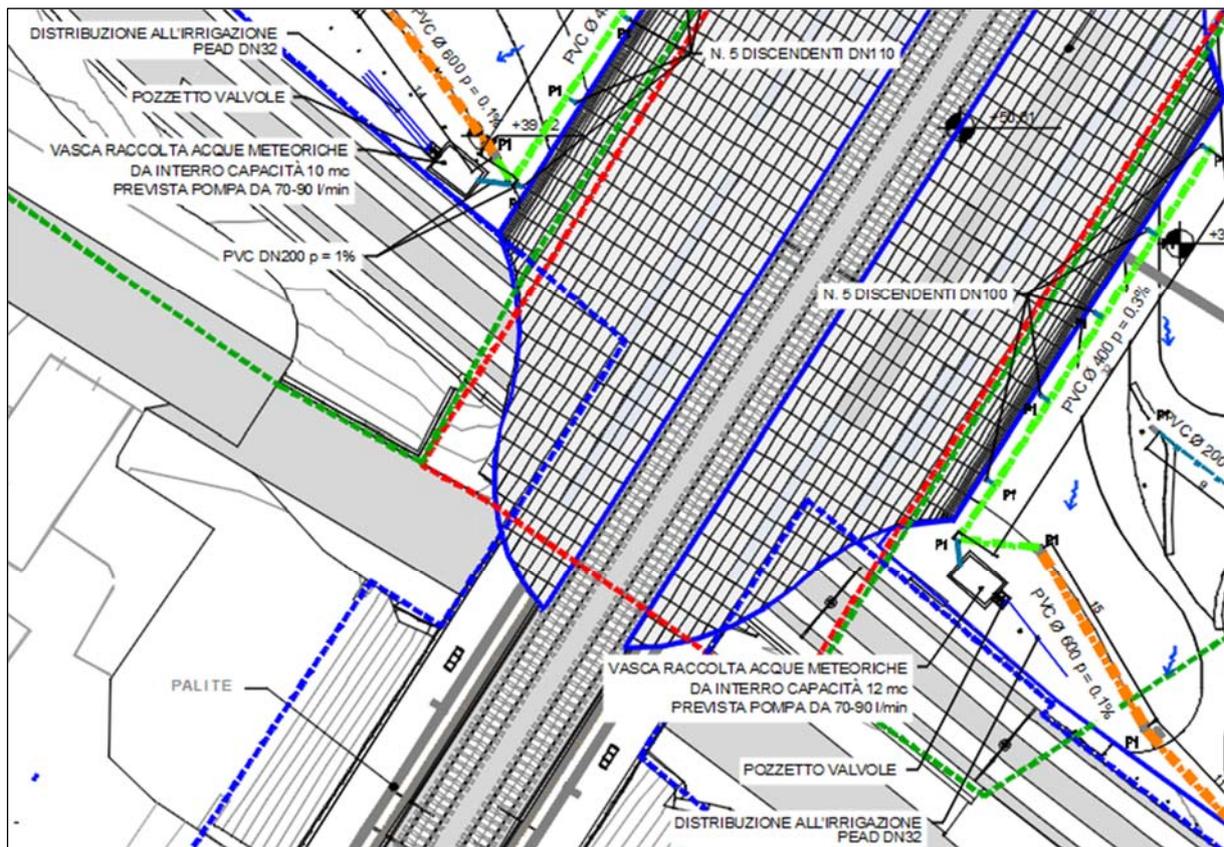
Stralcio planimetrico in corrispondenza dell'ubicazione delle vasche di raccolta acque piovane
